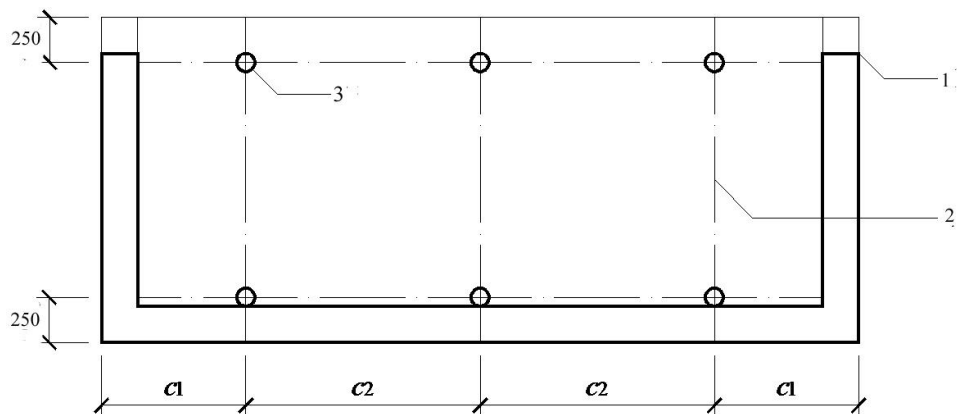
叠合板式阳台临时支撑架立杆平面布置示意
